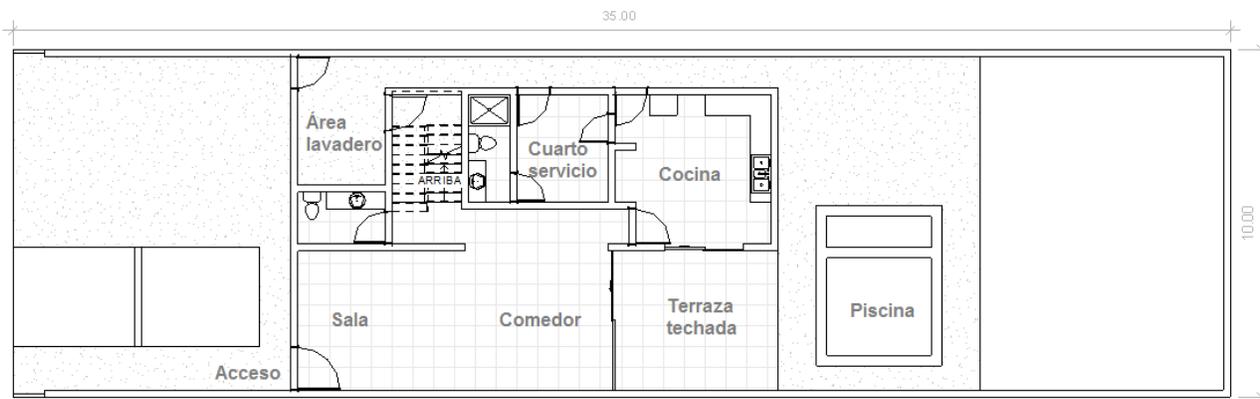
Croquis de vivienda tipo residencial plus, en planta baja
